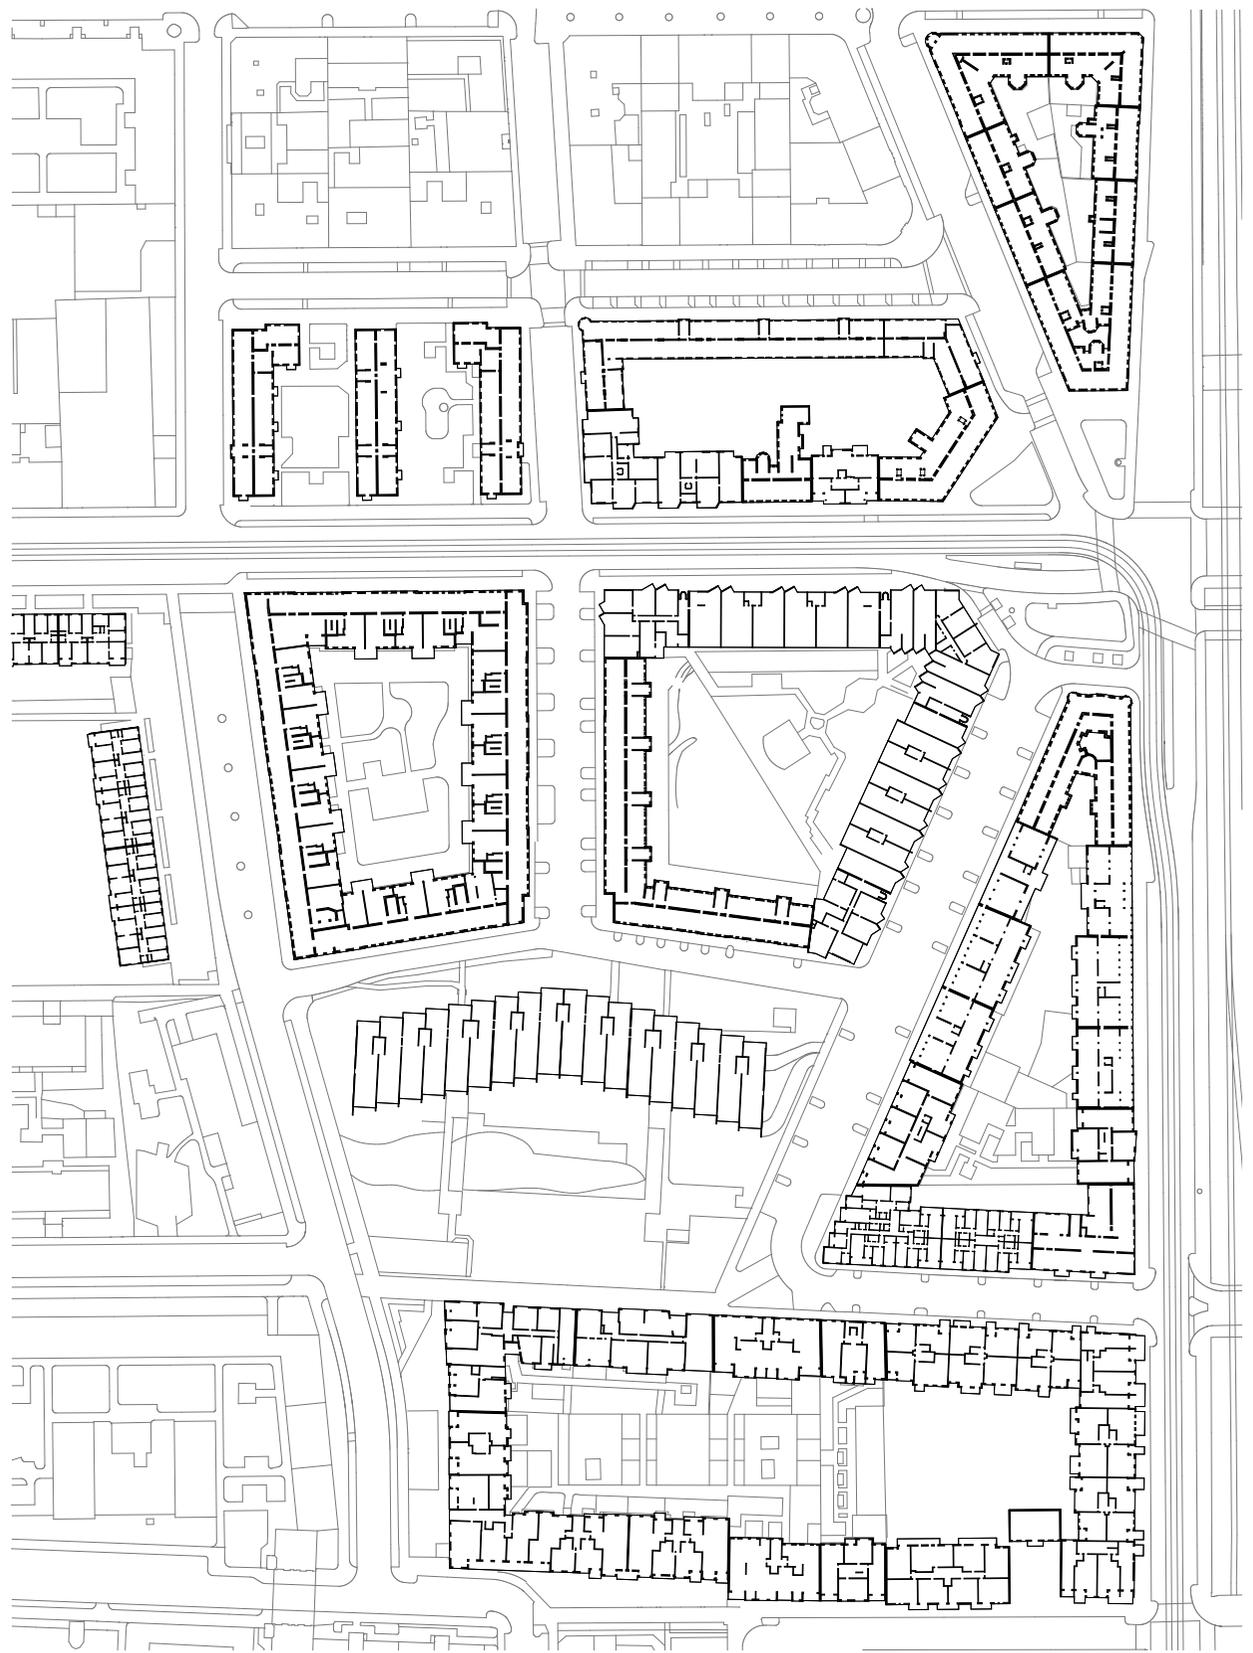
Lageplan komplementäre Wirklichkeiten, 1:2000
